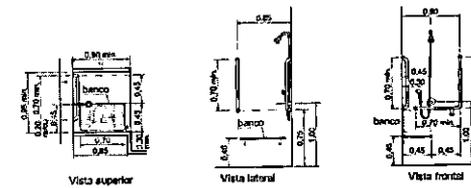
Boxe para chuveiro com barra de apoio em L — Exemplo
